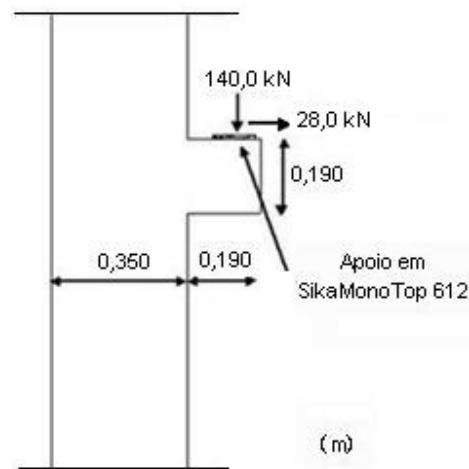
Corte na zona do pilar e da consola curta na direcção Y
